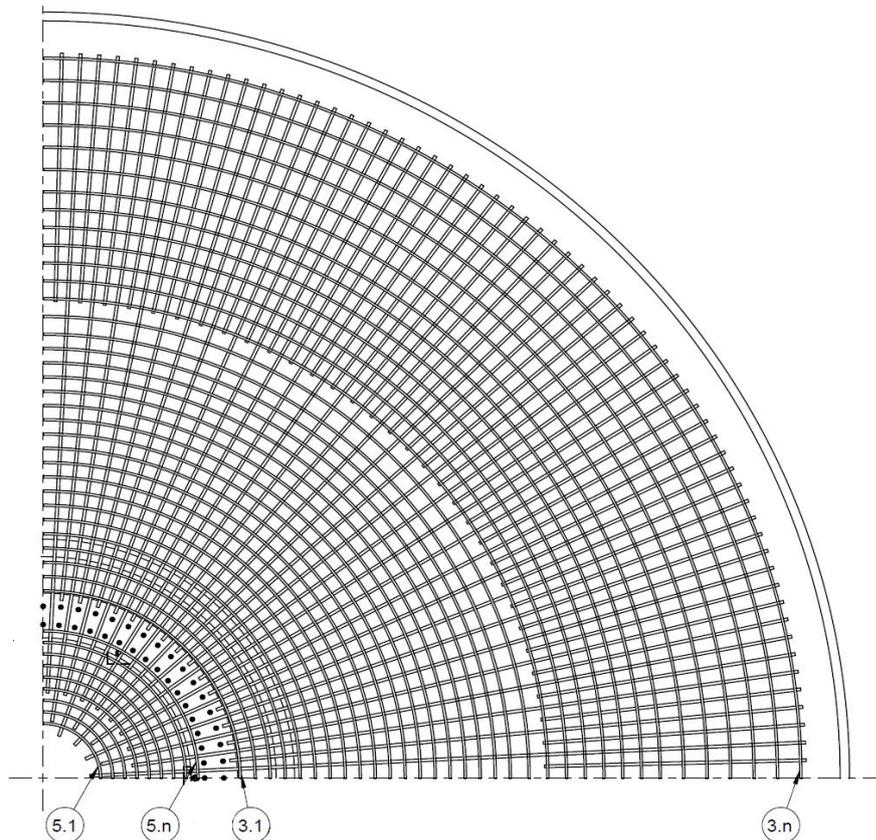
Untere Ringbewehrung ist oberhalb der unteren Radialbewehrung installiert.
